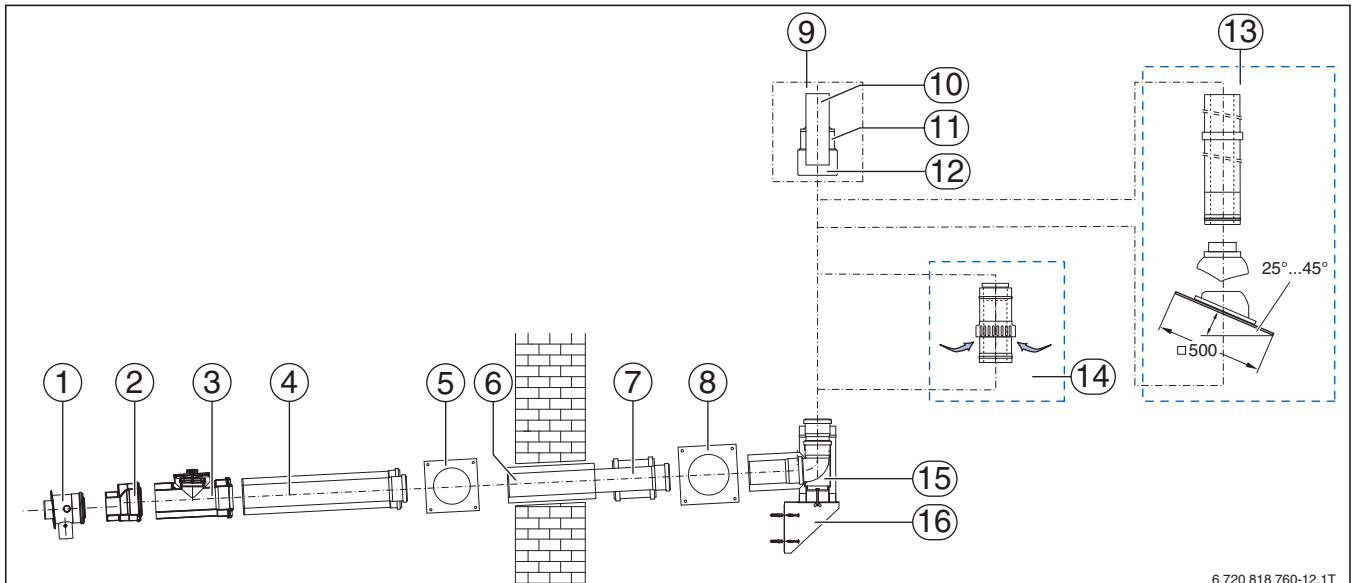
Montagevariante mit Bausatz GAF-K (Maße in m)
